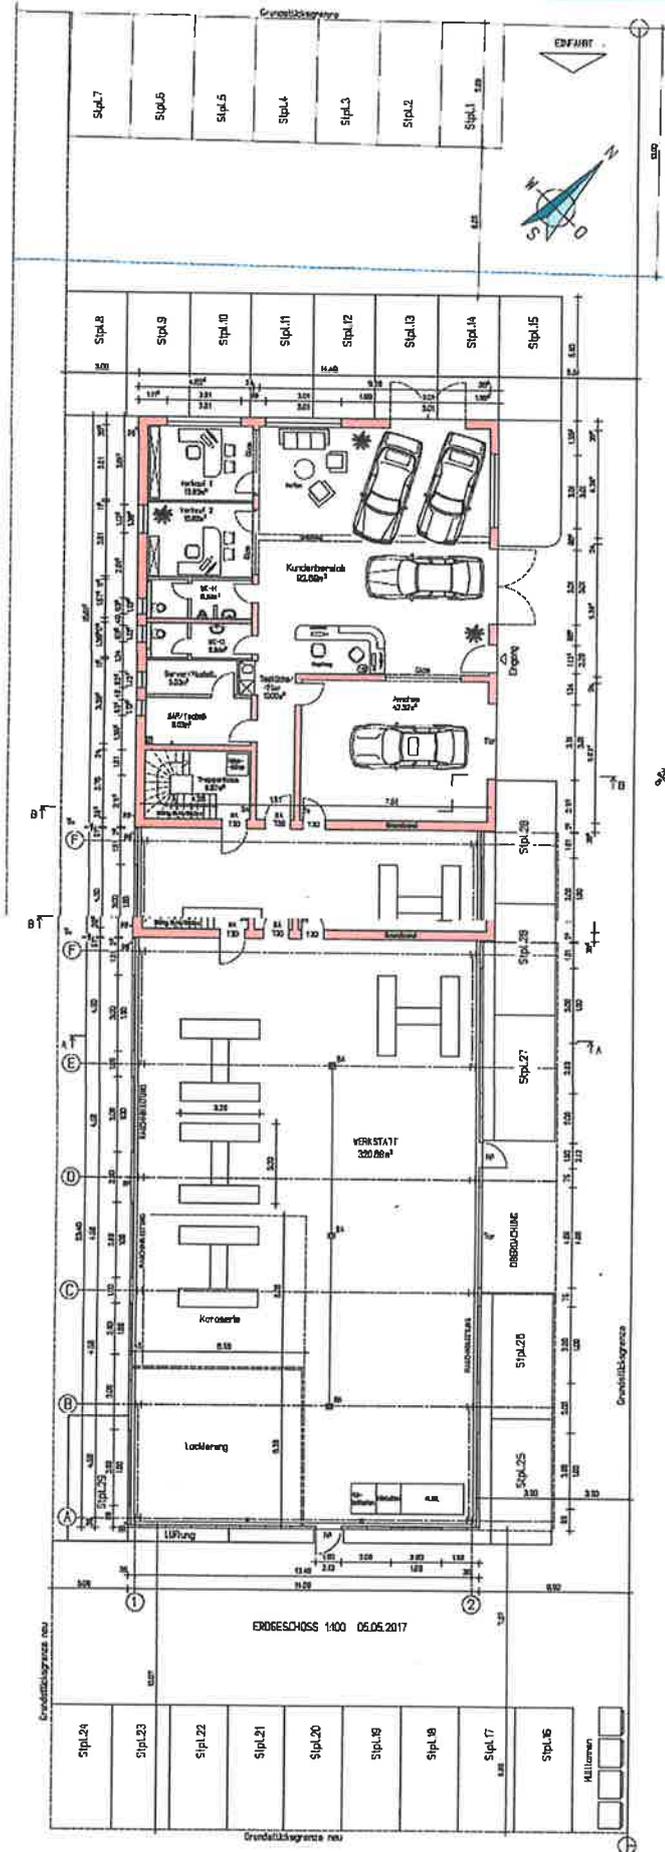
Lageplan Werkstatt (unmaßstäblich)
